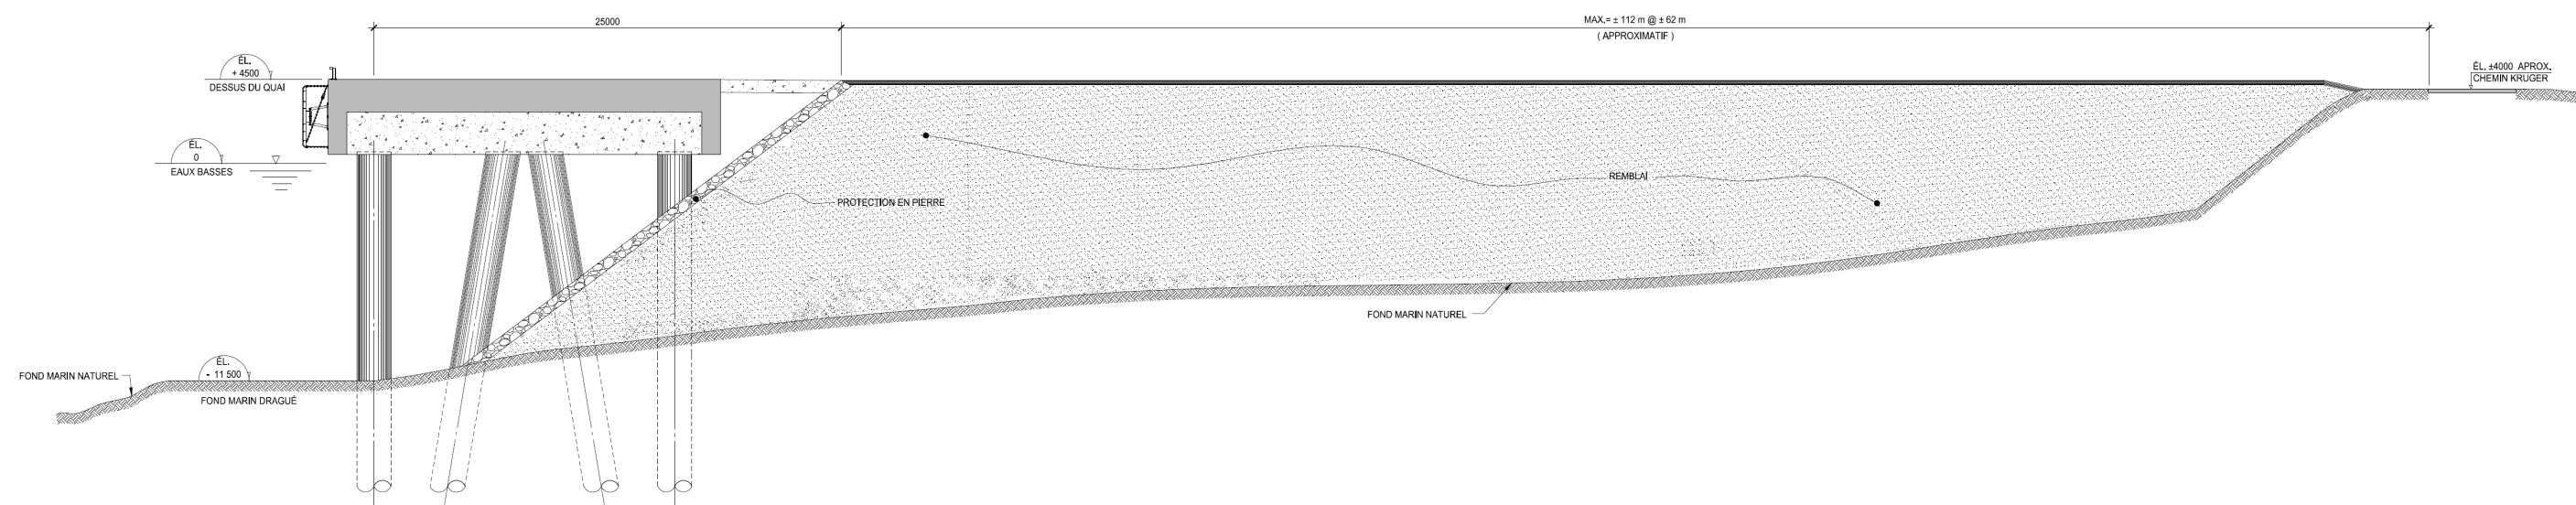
Coupe-type de la variante 4 -Dalle sur pieux avec entreposage
